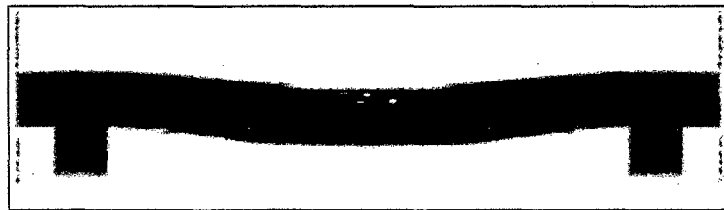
4. Ejemplo de fallo a flexión (compresión) en vigas de concreto. Fuente: (Stuardo P., 2008)
